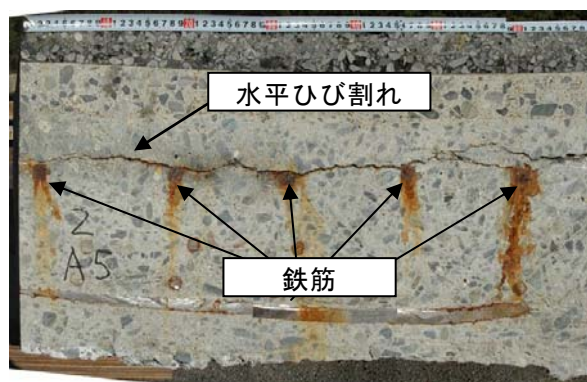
道路橋 RC 床版内部の水平ひび割れの発生状況
